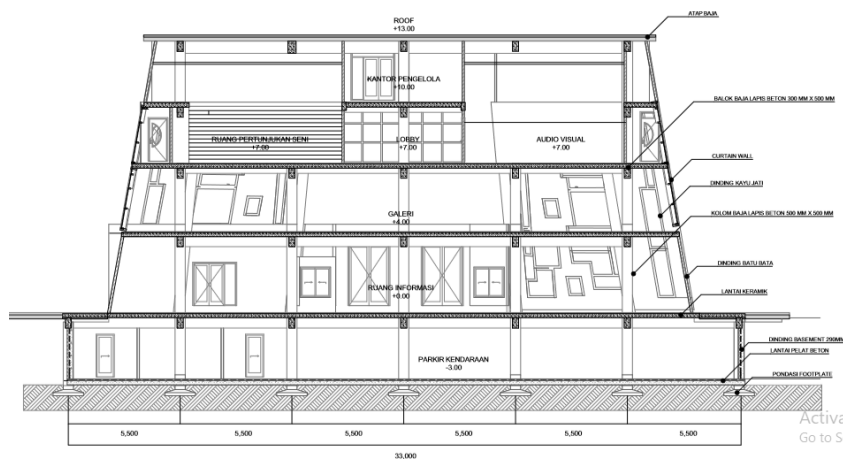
Struktur Kolom dan Balok 4rd Floor.
